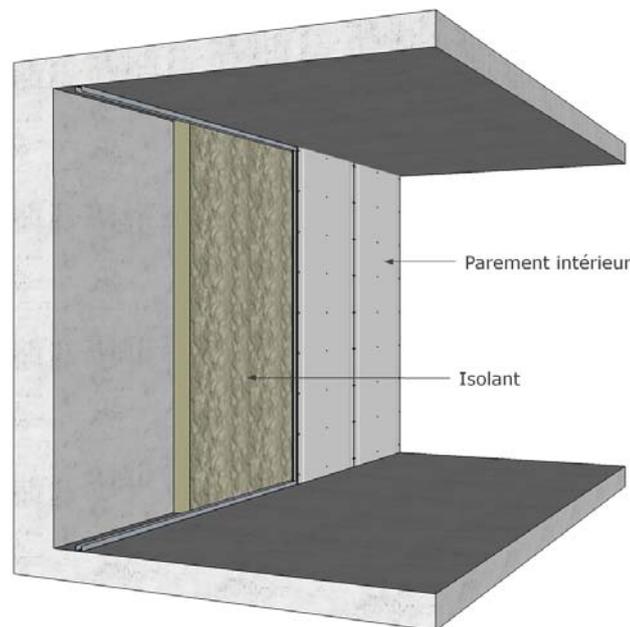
Contre-cloison constituée de fourrures simples ou doubles sans fixation intermédiaire au support avec lame d'air
